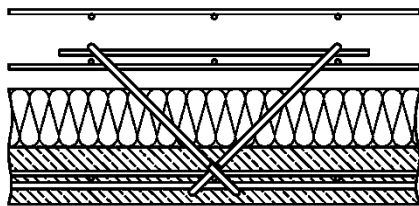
Obere Schicht bewehren, SPA-1 /-2
